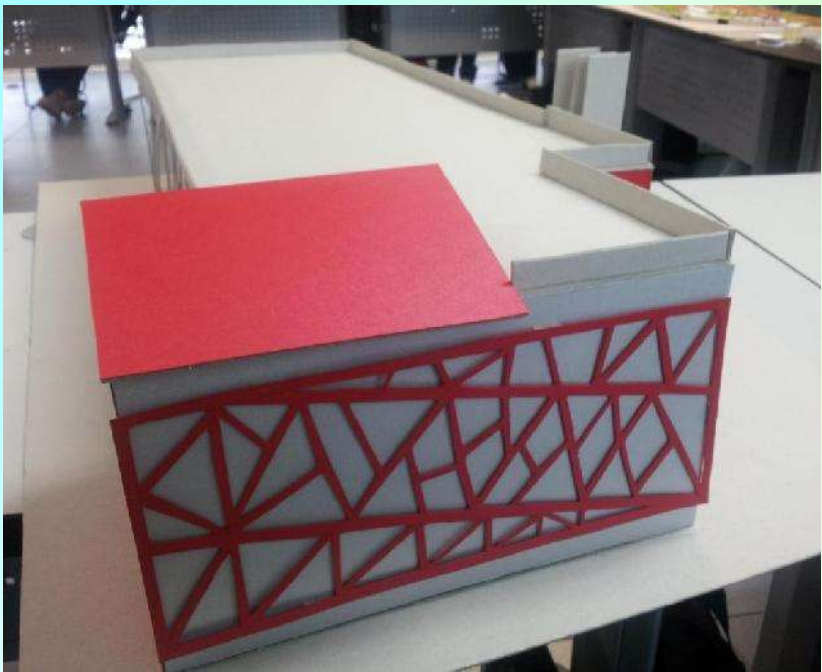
, Maqueta Conceptual Fachada Oeste, Foto EDGM
